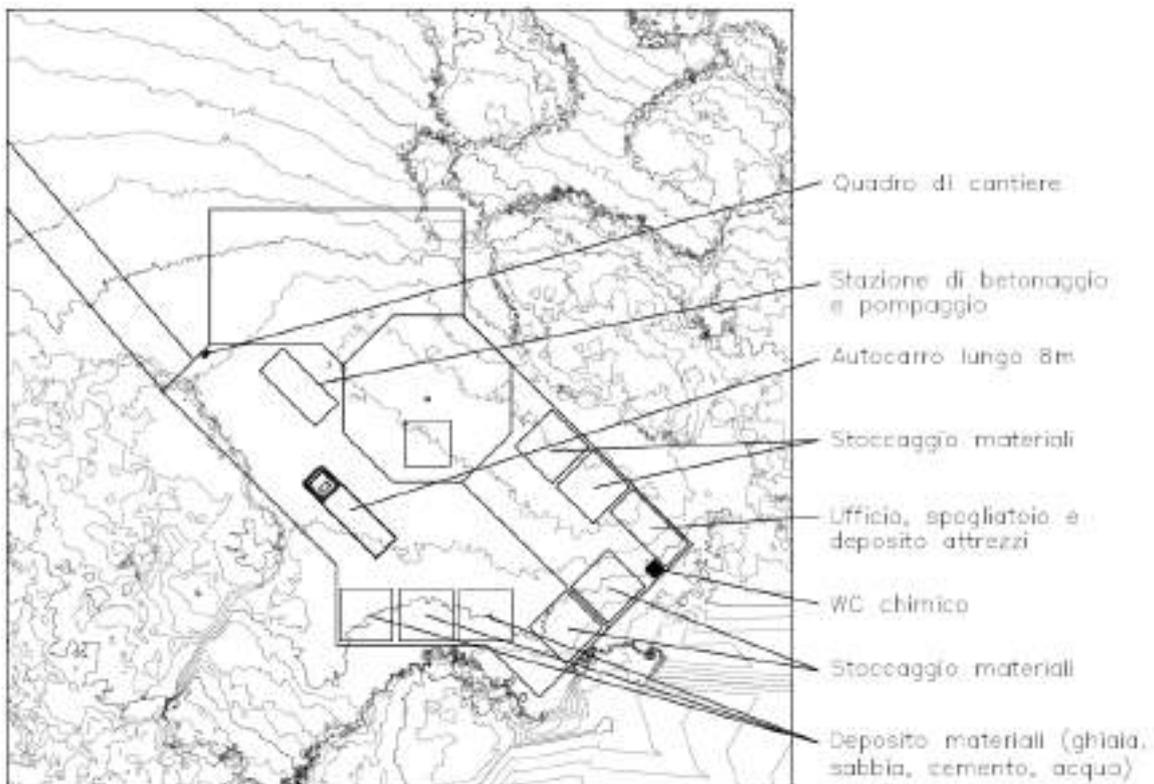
QUARTA FASE: strutture in elevazione in acciaio, ala tecnica ed ala uffici.
